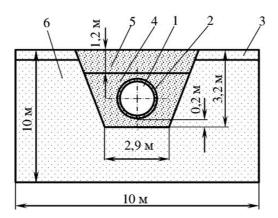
Схема к расчету температурных полей в грунте, окружающем теплоизолированный газопровод:
